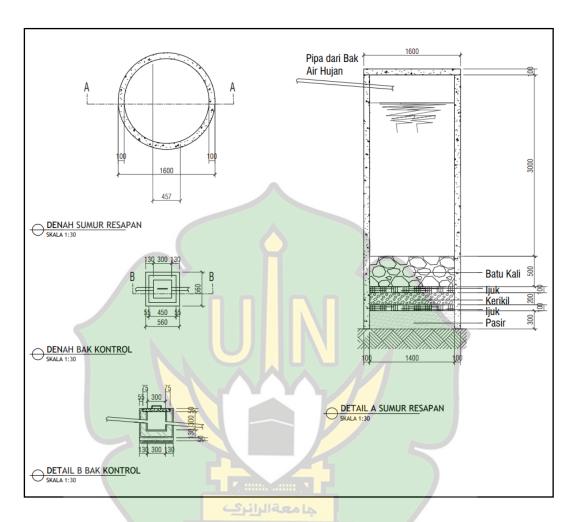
Rencana Air Hujan Bangunan Utama
